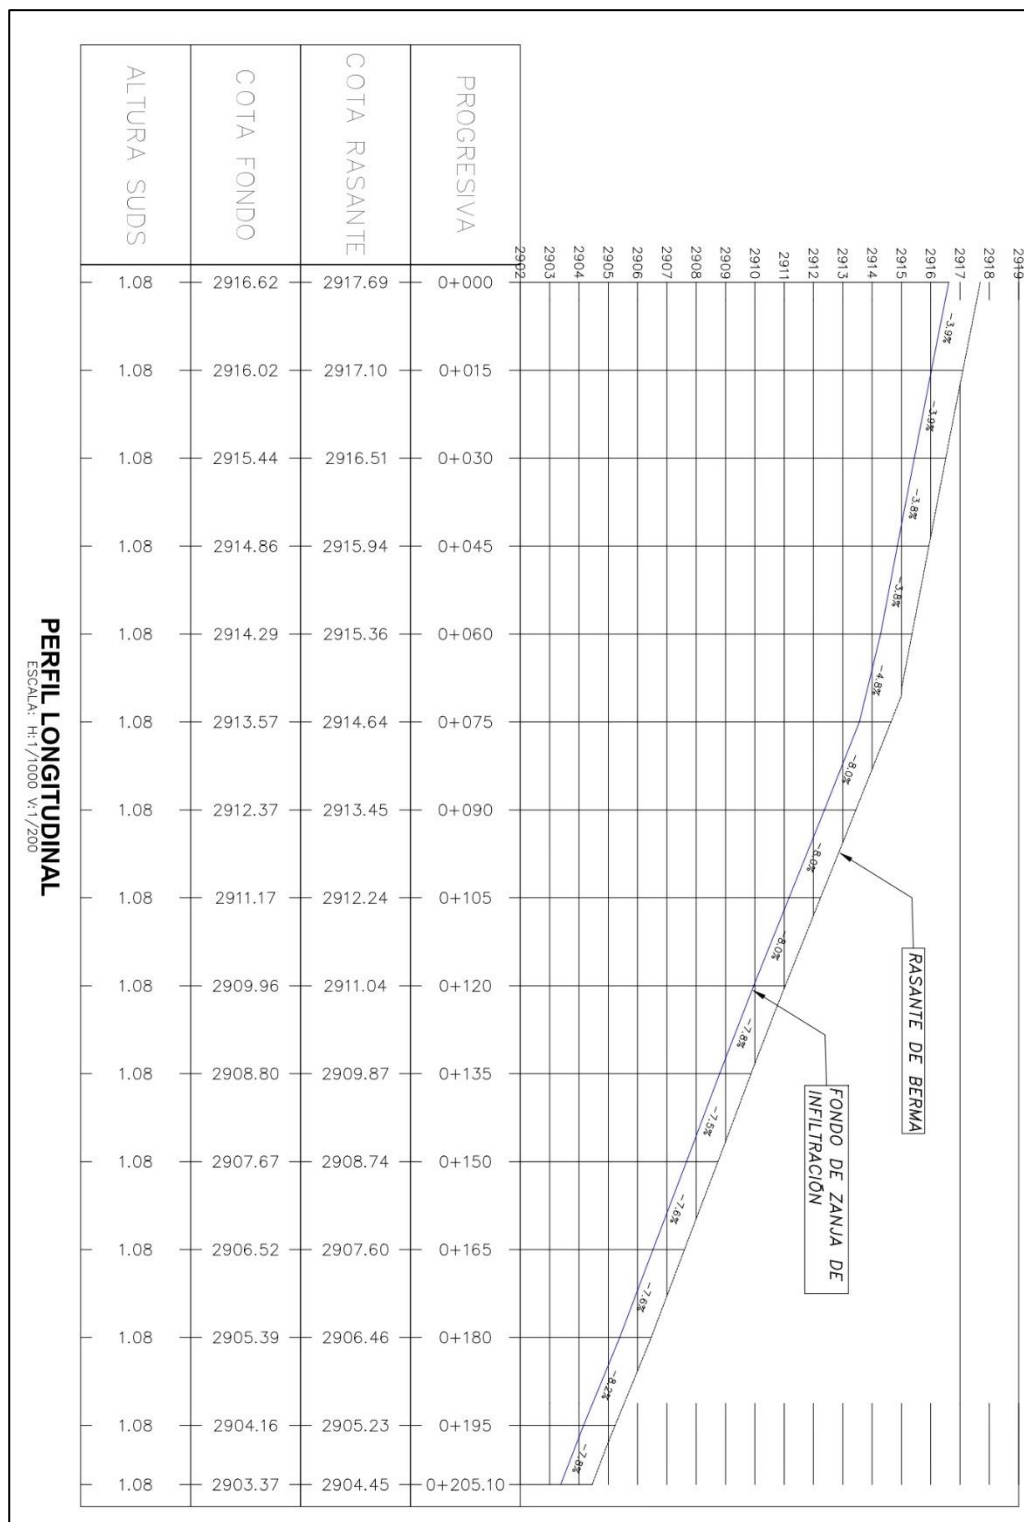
Perfil longitudinal de la zanja de infiltración (IFT04)
